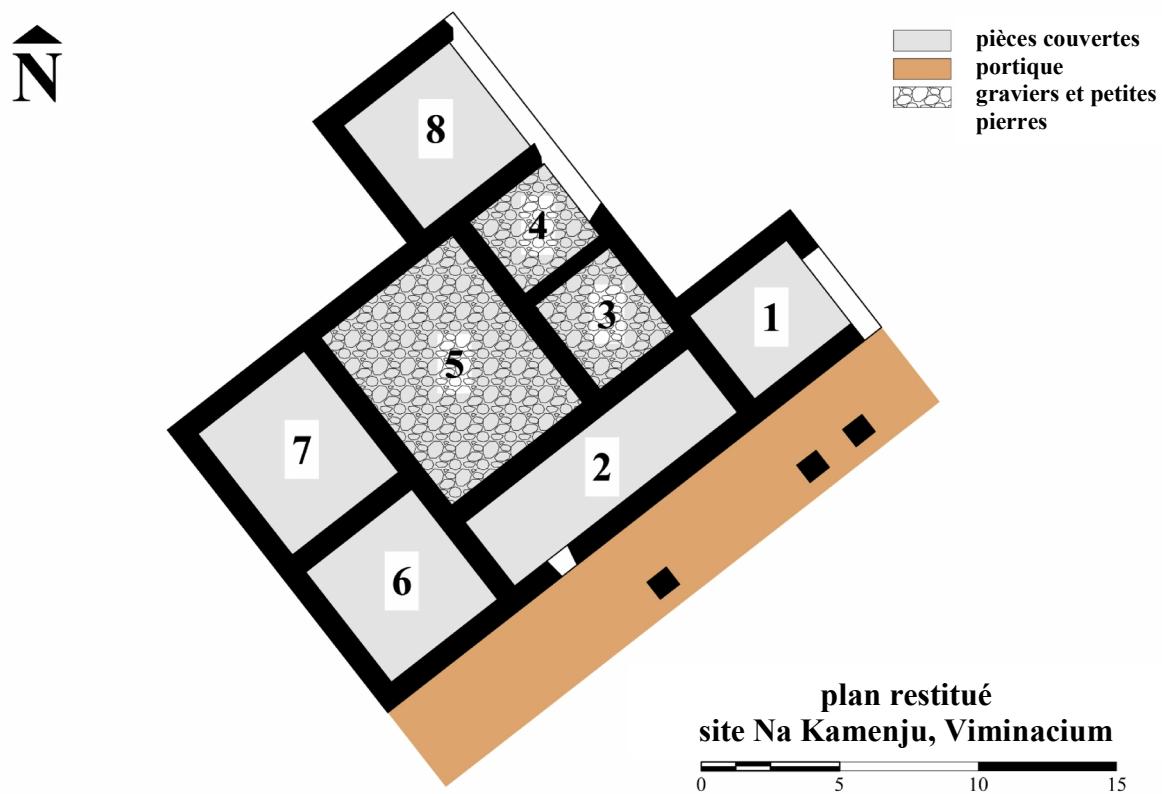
/5, Plan restitué de l'édifice, site Na Kamenju, A. M. d'après Голубовић, Копаћ, 2008, 34
